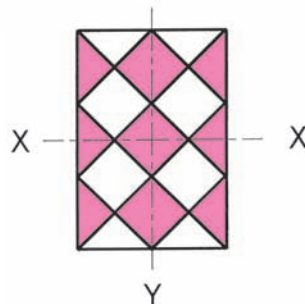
à 22 : Implantations de dalles de marbre ou de carreaux en diagonale avec ou sans bordure
